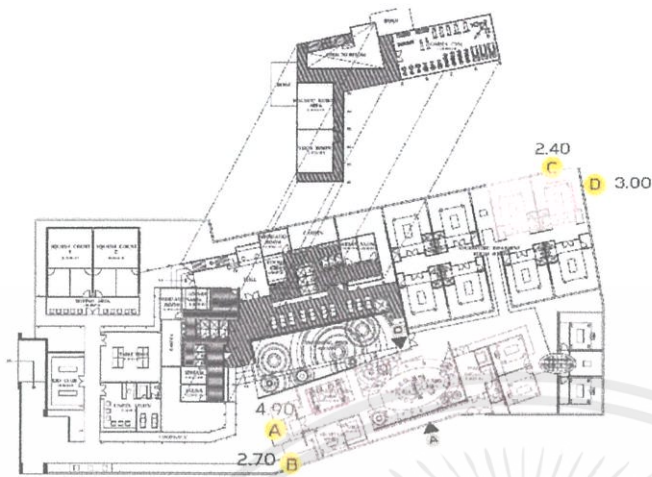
Elevation 3 (Leisure Spa & fitness)
